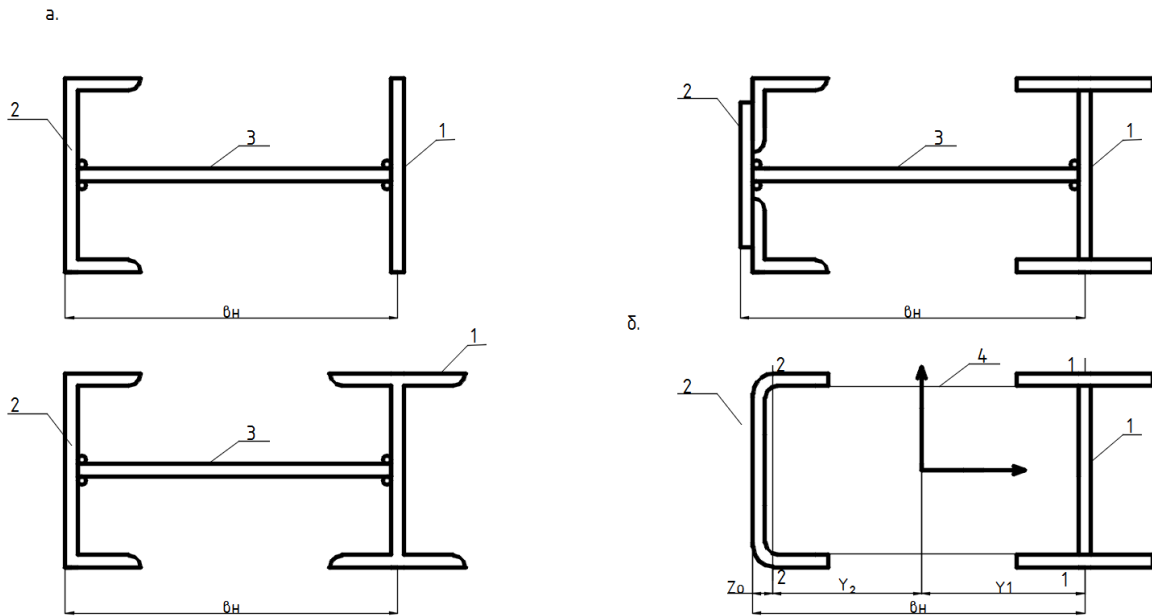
Варианты сечений колонн со сплошной стенкой (а) и вариант сечения сквозной колонны (б): 1- крановая ветвь; 2- наружная ветвь; 3- стенка; 4- решётка.
